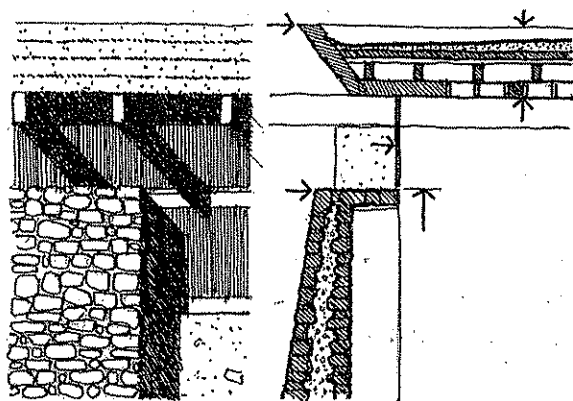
Detalle Crítico Casa en Balcarce: Almeida Kurth
